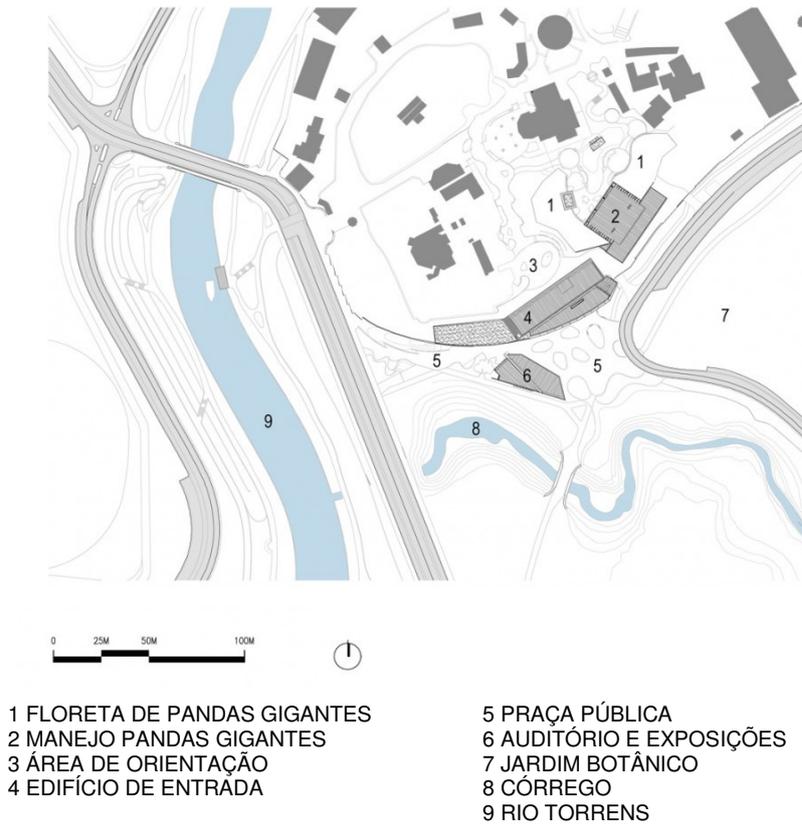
planta de situação com a Floresta de Pandas Gigantes e o edifício de entrada
